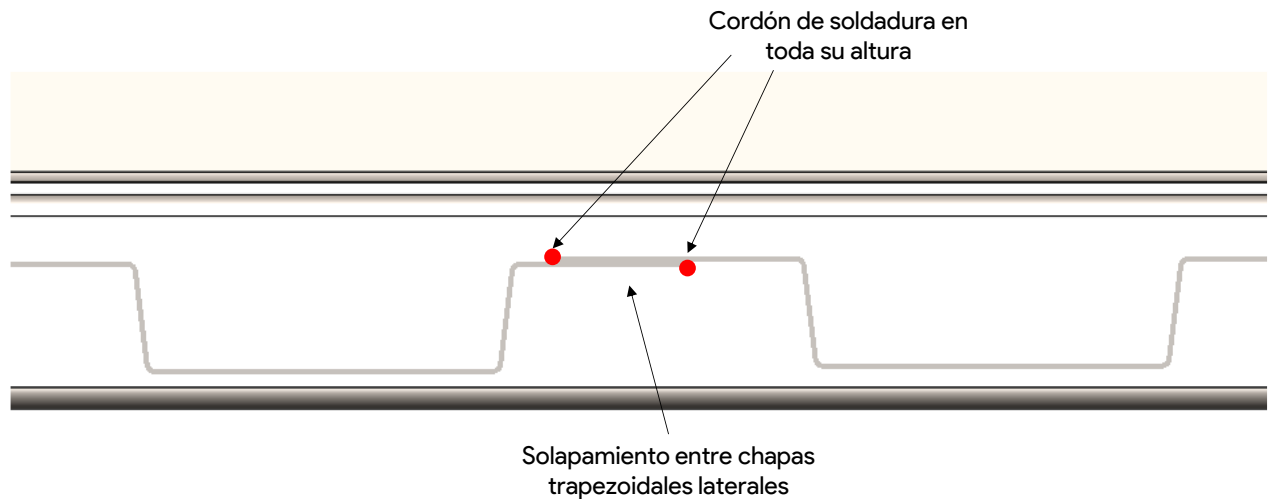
Vista superior donde se observa el solapamiento entre las chapas trapezoidales.
